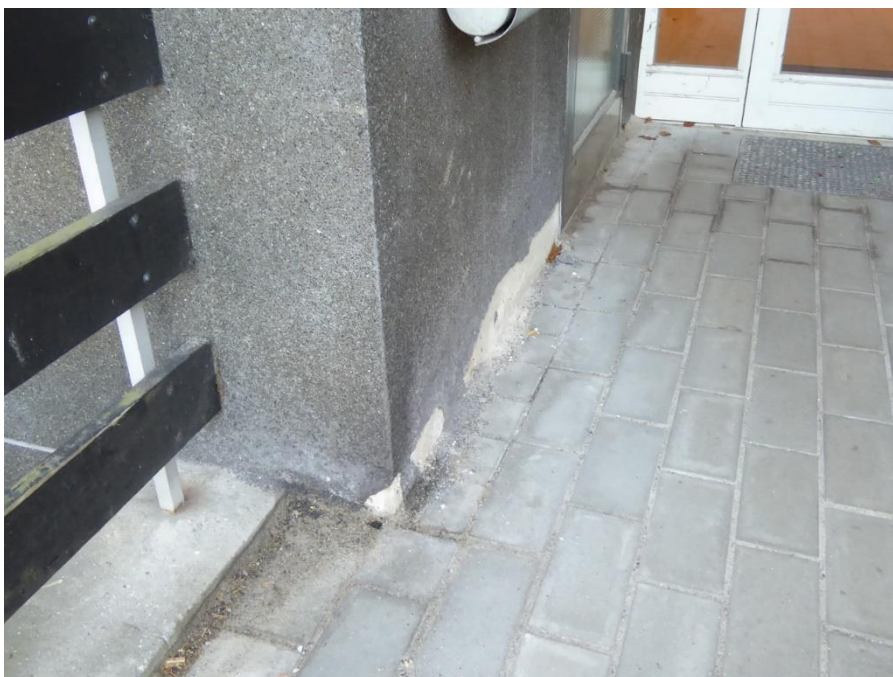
Revnet puds, blok 1 stueetage
